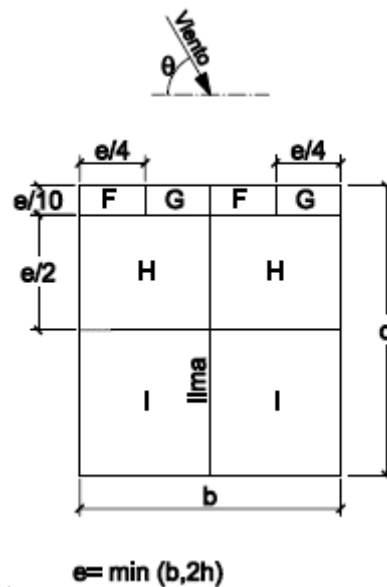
Zonas en planta de la cubierta donde actúa el viento frontal. (Figura D.6 del CTE DB SE-AE)
